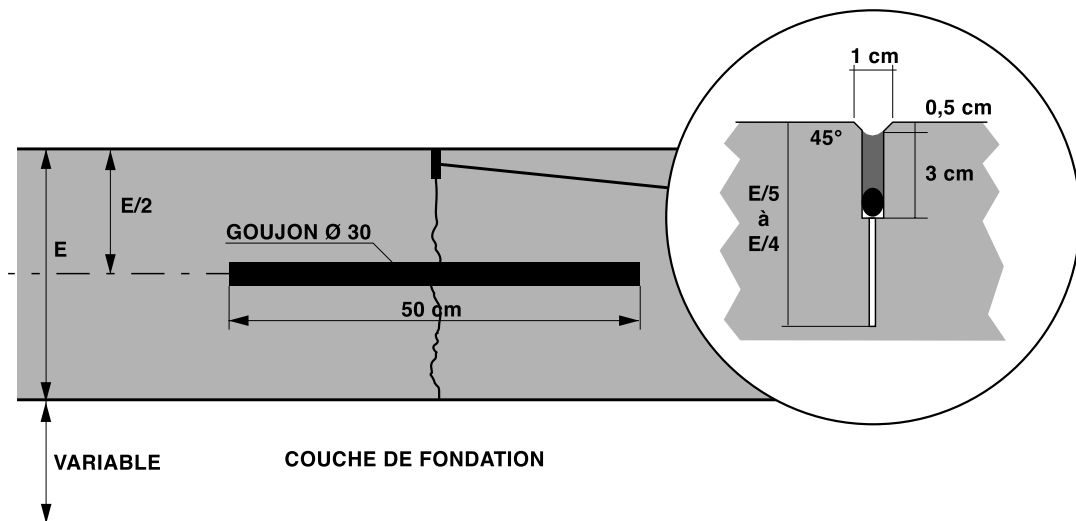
Dalles goujonnées : coupe longitudinale au niveau d'un joint de retrait
